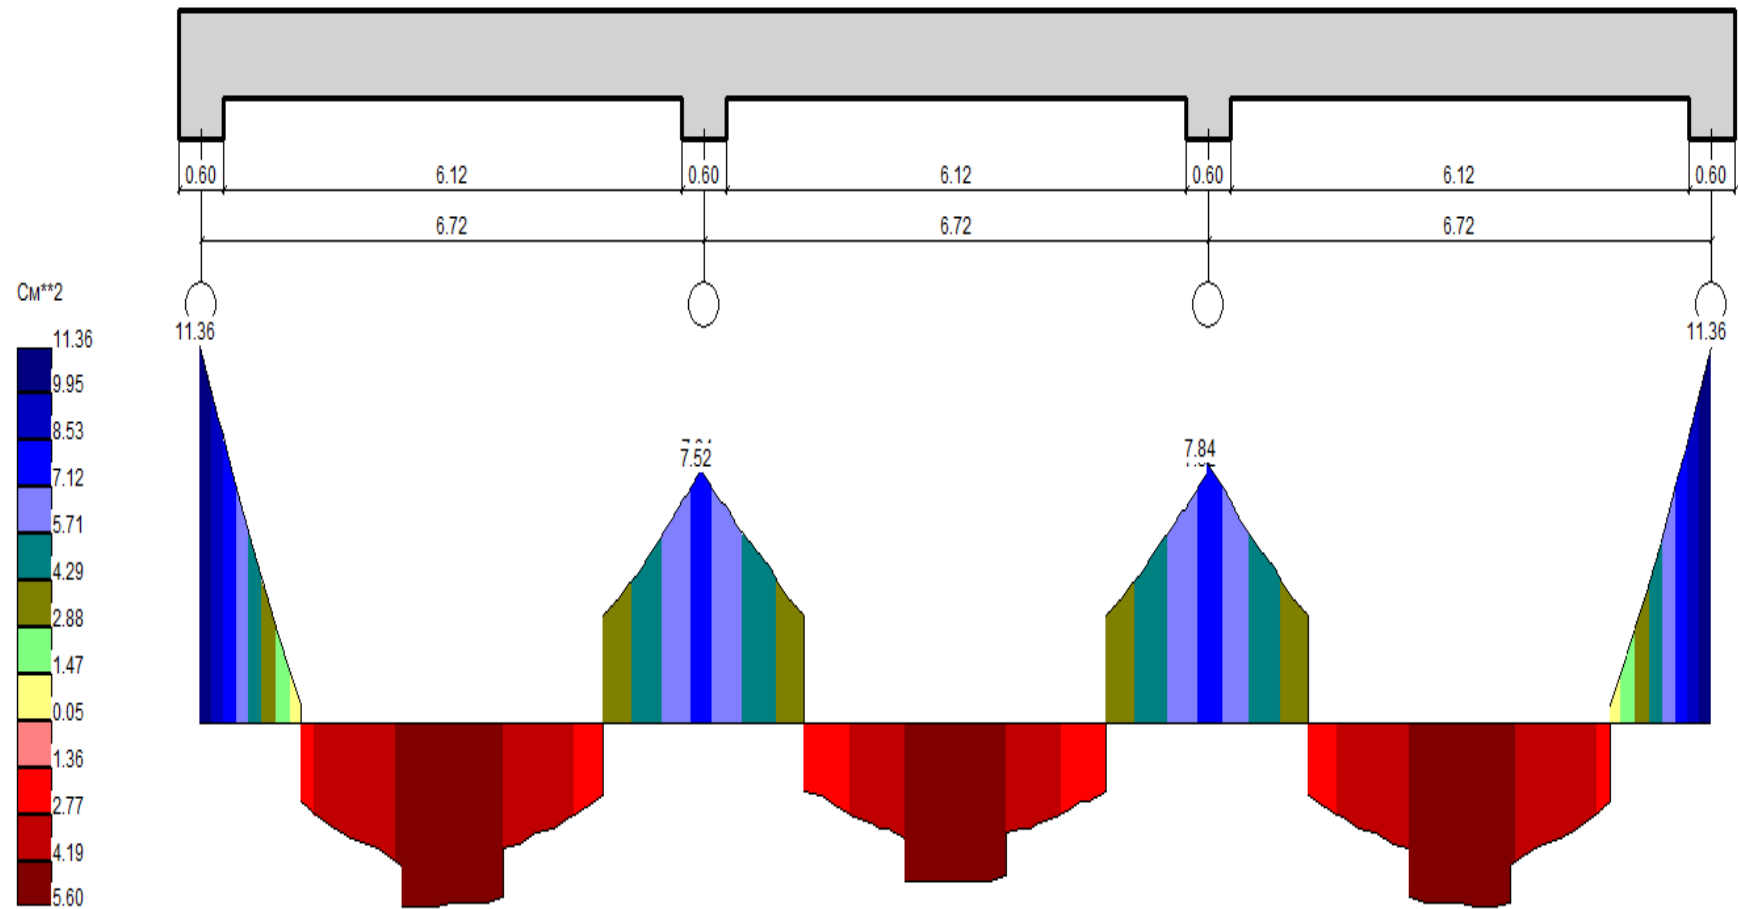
Варіант будинку з балочно - плитним перекриттям. Балка Б1-3.
